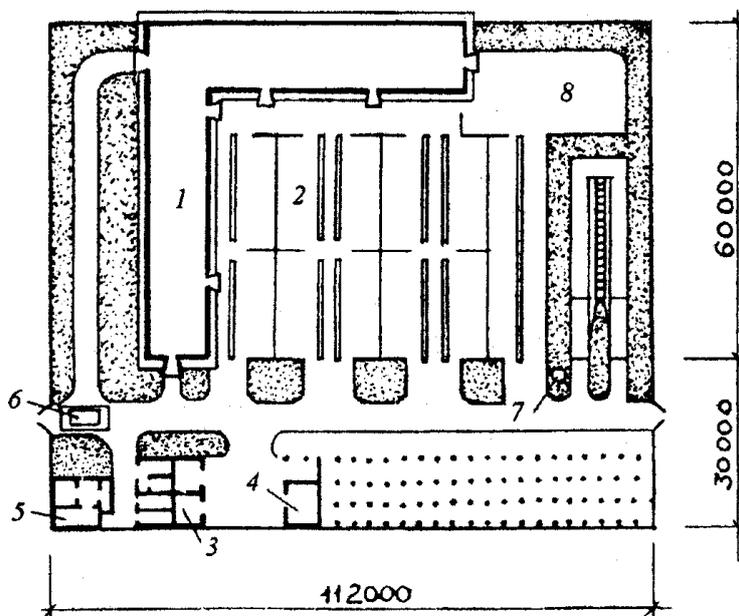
Генеральный план овцеводческой фермы на 600 маток:
